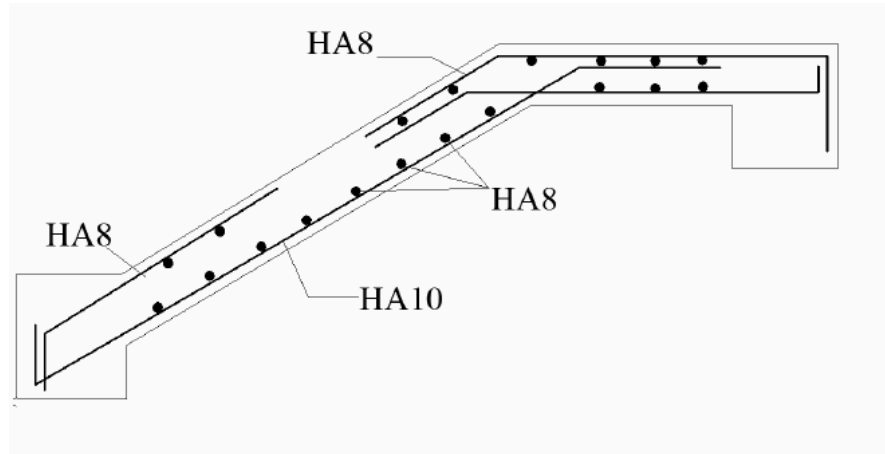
Schéma de ferrailage de l'escalier type 3 (1er et 3eme volée)
